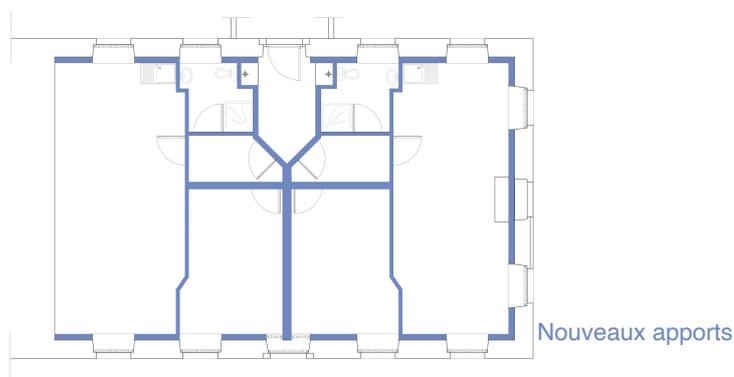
Plan actuel du rez-de-chaussée, mettant en évidence les nouveaux apports. Source : Sophie Rulkin.
